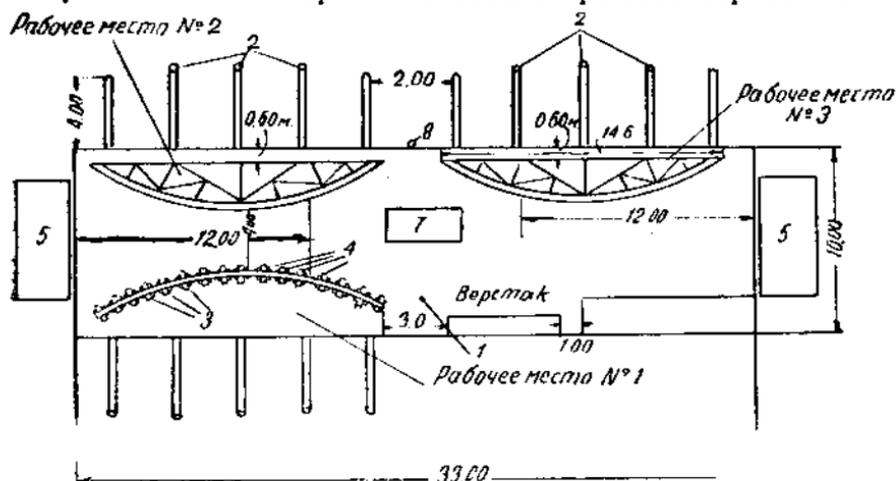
Схема рабочего места: 1—бок из досок; 2—опорные столбы для готовых ферм; 3—ваймы; 4—клинья; 5—доски для пояса; 6—заготовка углового железа для решетки ферм; 7—поковки, болты, гвозди и пр.; 8—столбы для подводки электроэнергии.
